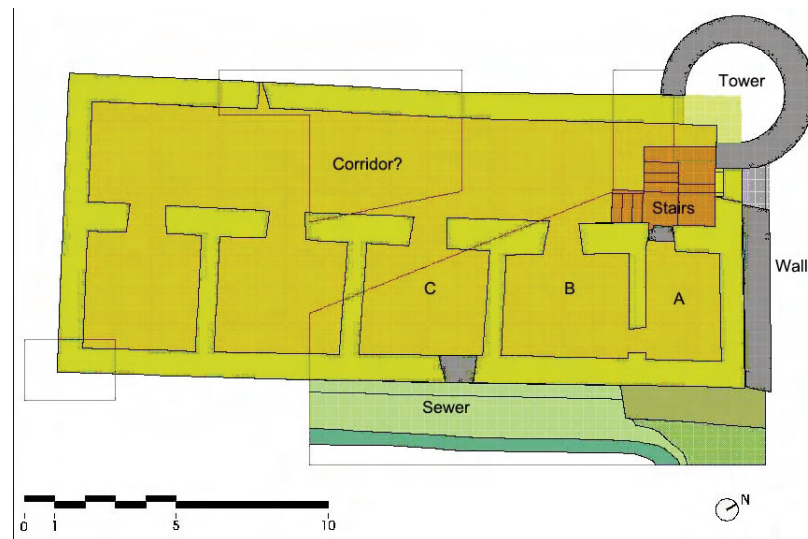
Planta hipotética del edificio a partir de las zonas excavadas. La distribución corresponde a la segunda fase de ocupación.
